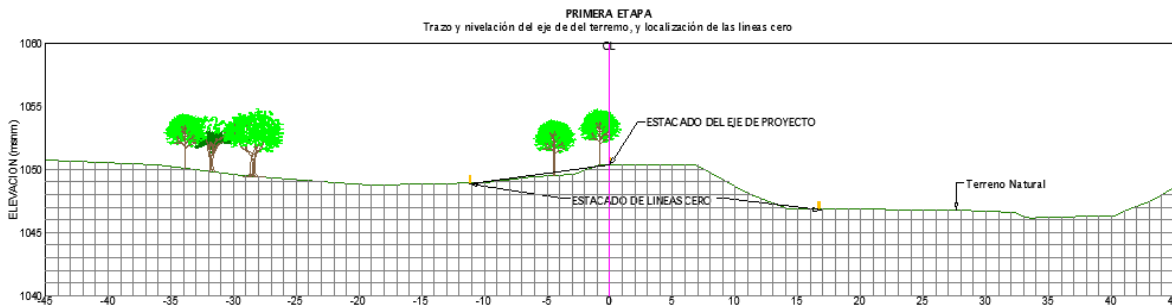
Ejemplificación de la etapa de Trazo y nivelación del eje del terreno y localización de las líneas cero para la construcción de terraplenes en las obras aplicables que comprenden el proyecto.
